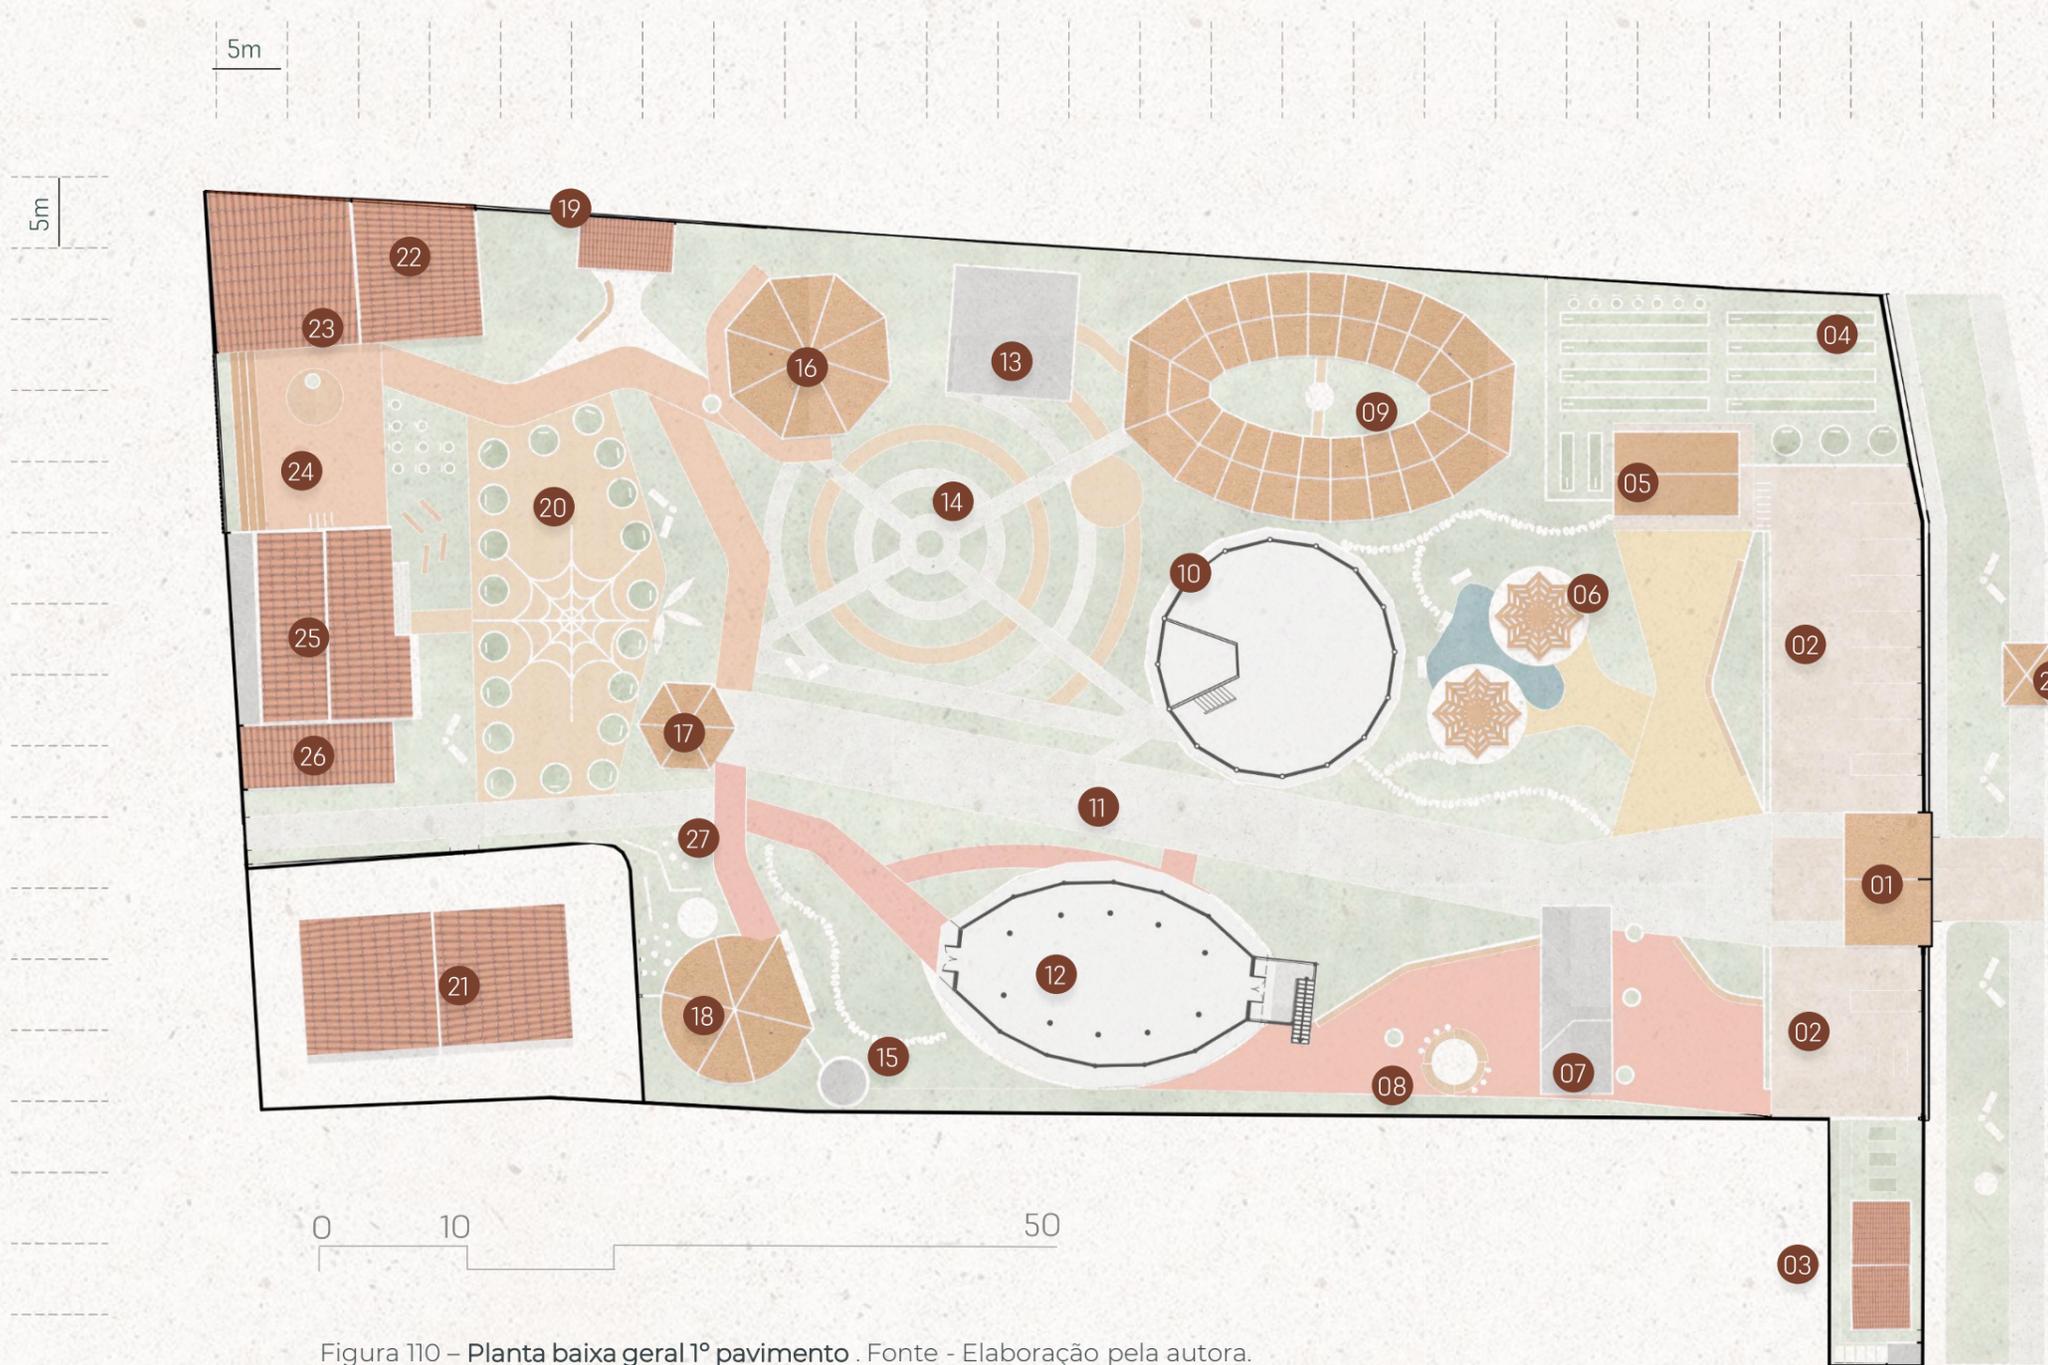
Planta baixa geral 1º pavimento . Fonte - Elaboração pela autora.
